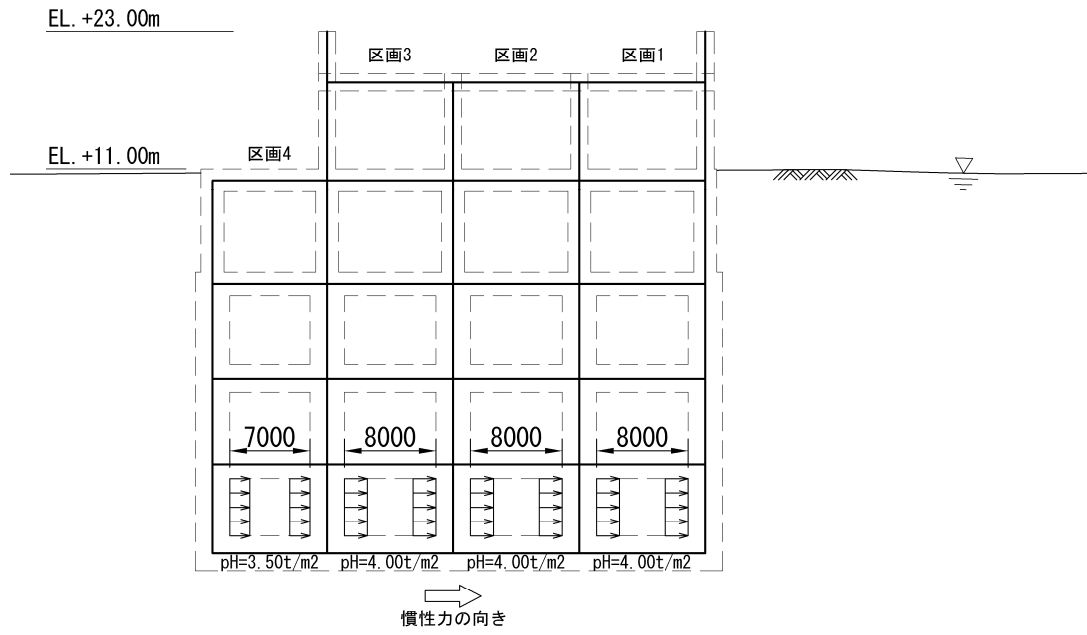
(1) 水平動による動水圧図 (南北方向⑤-⑤断面)
